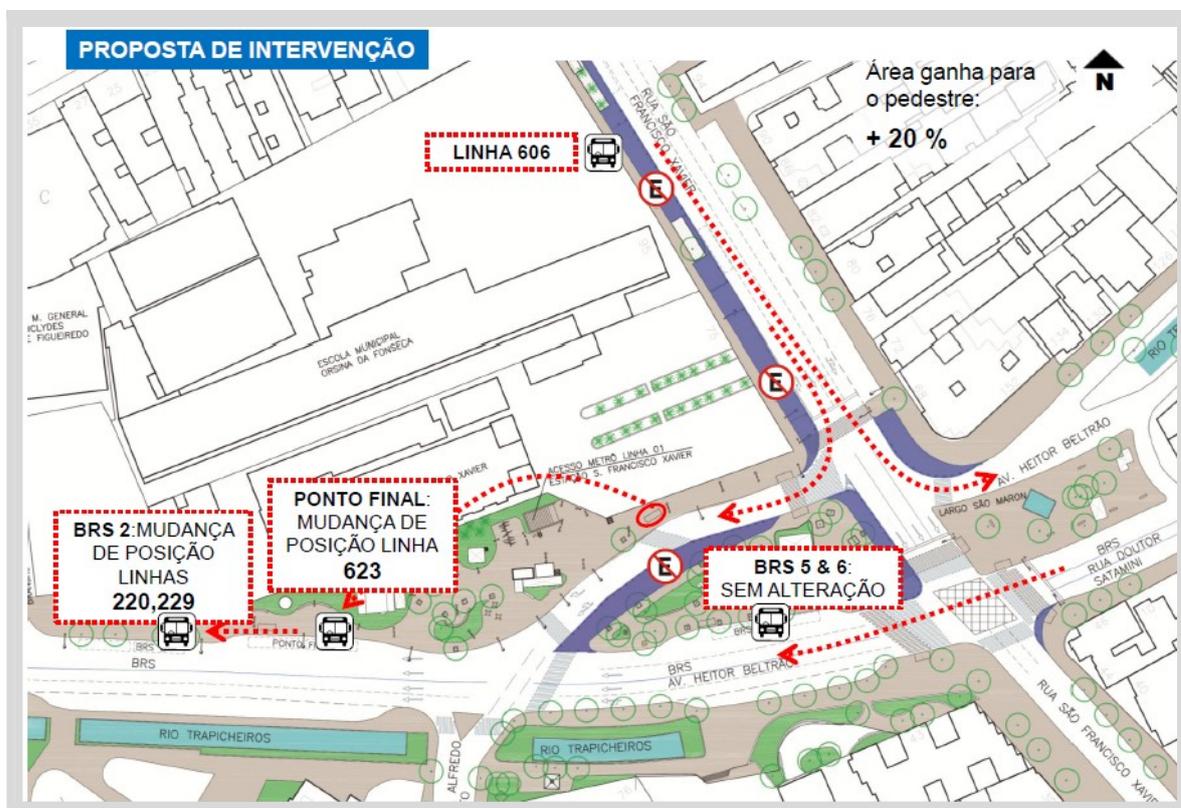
Planta baixa do projeto de intervenção temporária Praça São Francisco Xavier
